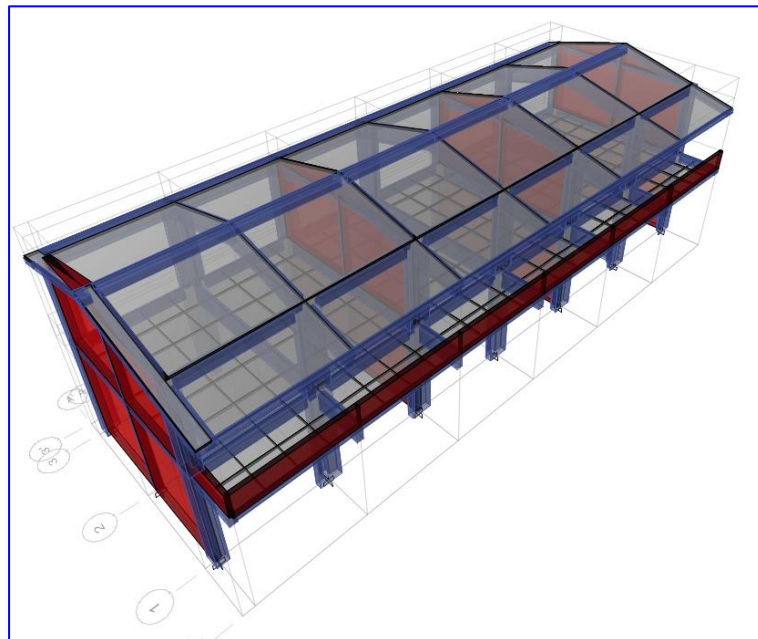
Vista 3D de Pabellón A modelado en ETABS
